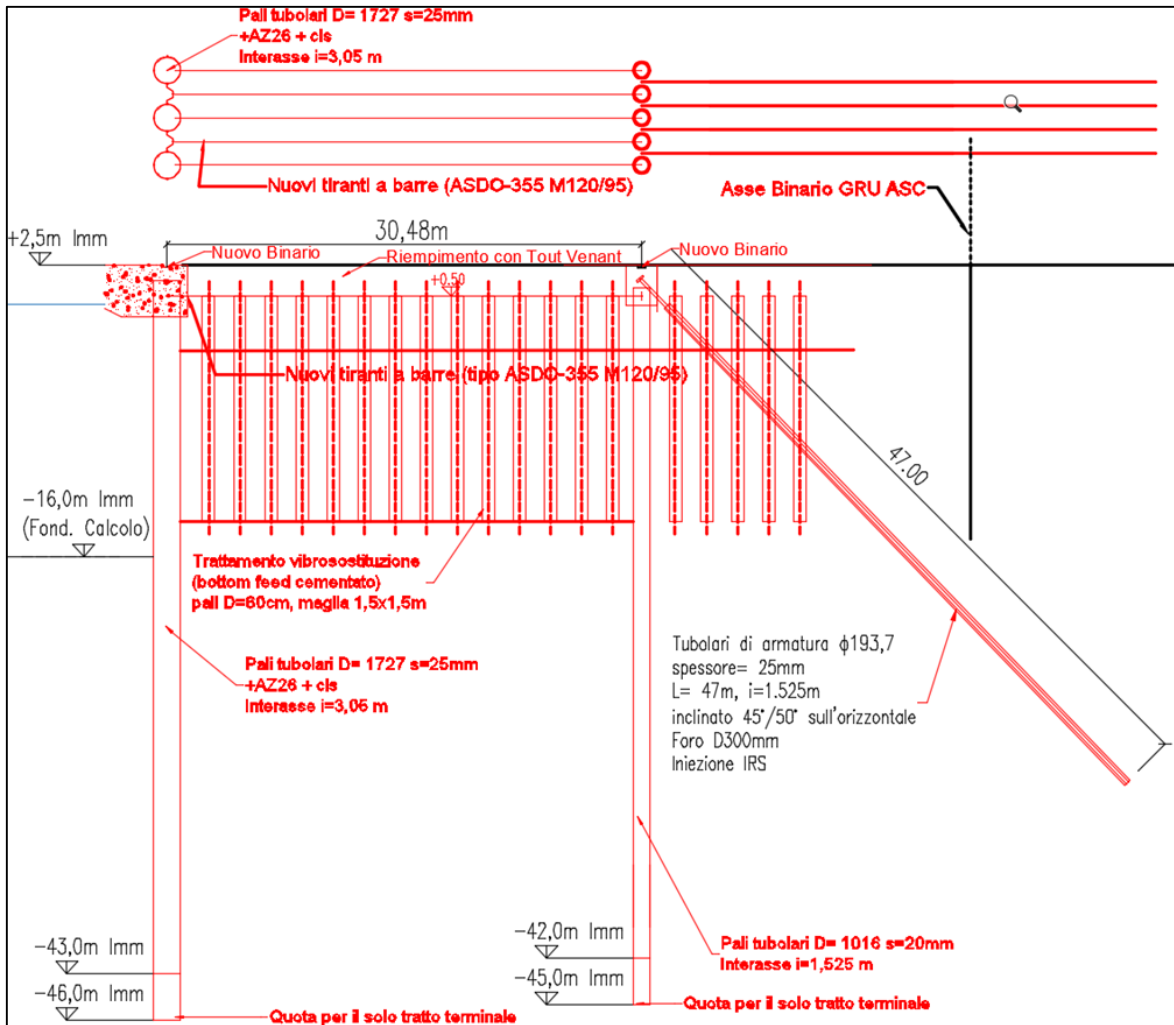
Nuova Banchina Ravano: sezione rappresentativa dell'intervento
